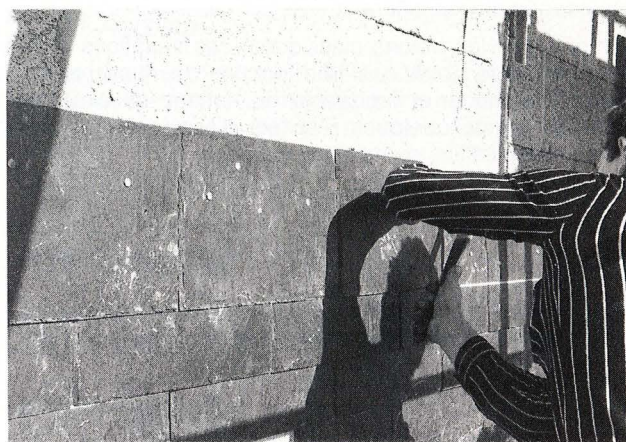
Pose d'écailles en ardoise pour bardage par clouage sur murs en béton de bois (Fixolite)
